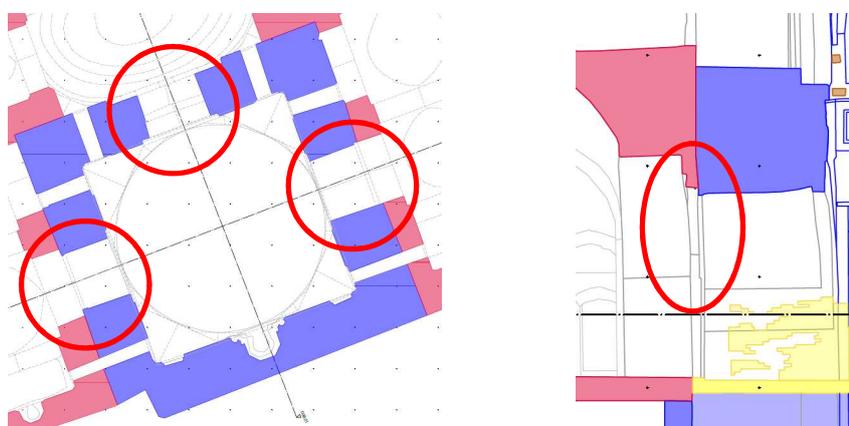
Plan - Iran_Borujerd_Baualterspläne-002.01_A1_Grundriss EG_1-100
